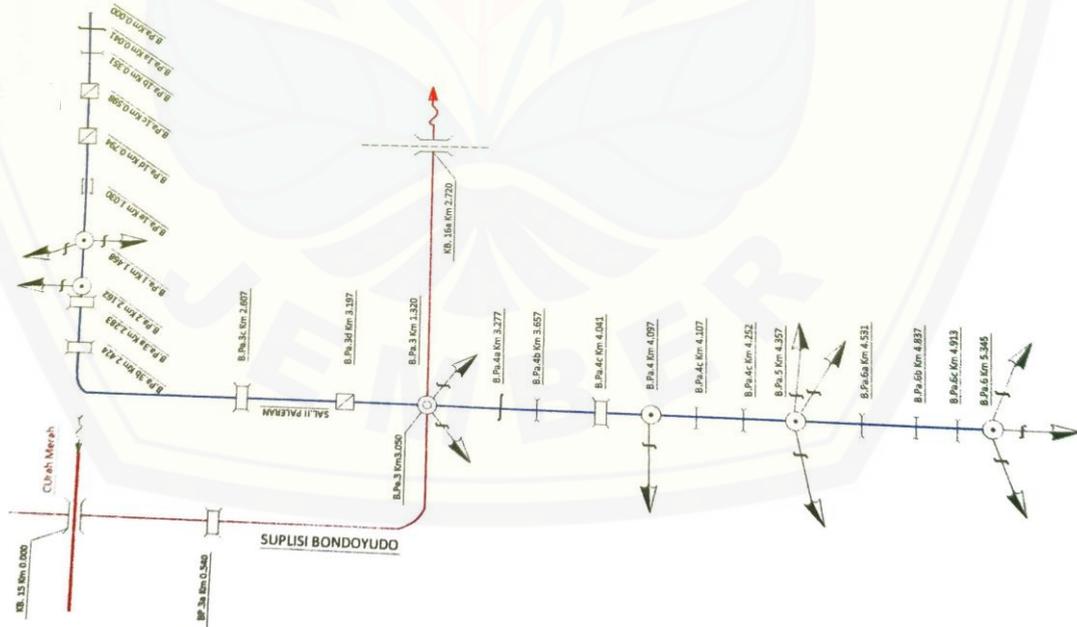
Detail titik awal saluran irigasi sekunder Desa Paleran
